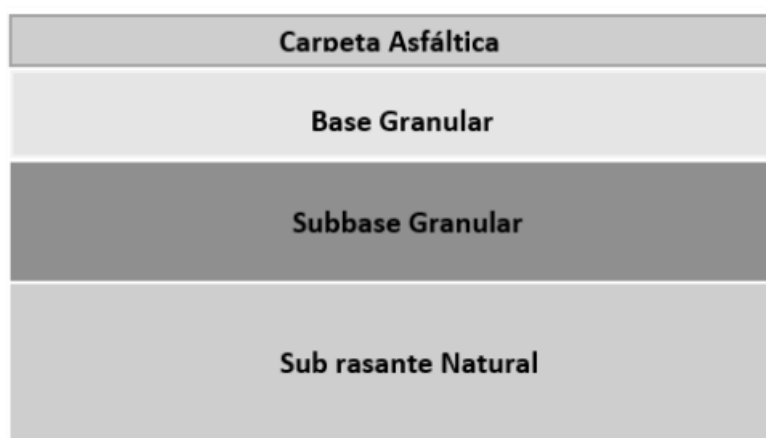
Estratos de un pavimento asfáltico o de concreto flexible
